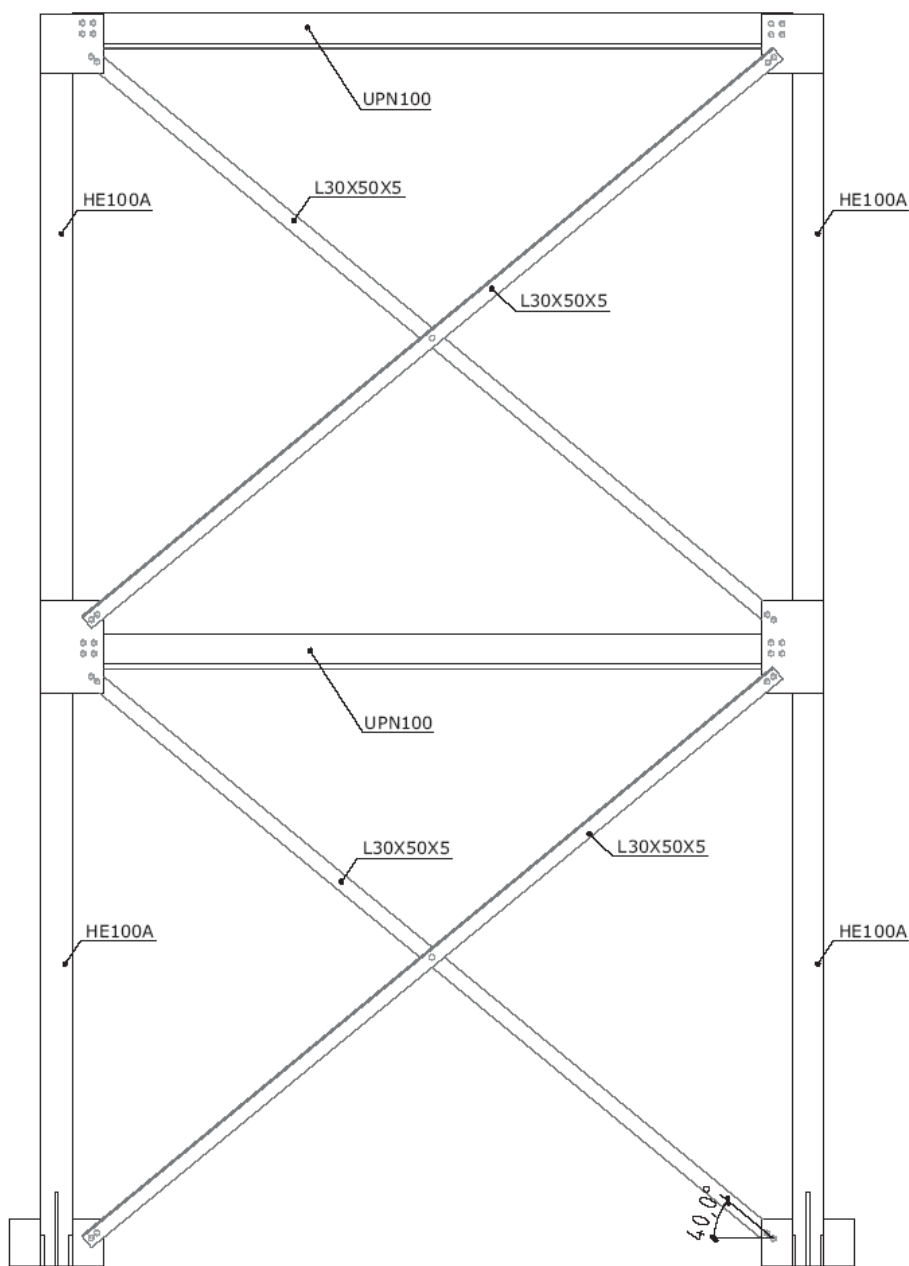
Prospetto del telaio (il lato rappresentato è quello corrispondente alla dimensione in pianta di 2.4m)
